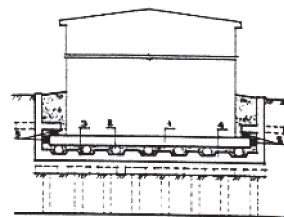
Сейсмостойкий фундамент в слабых грунтах с использованием свайного ростверка и сейсмоизолирующей подушки
